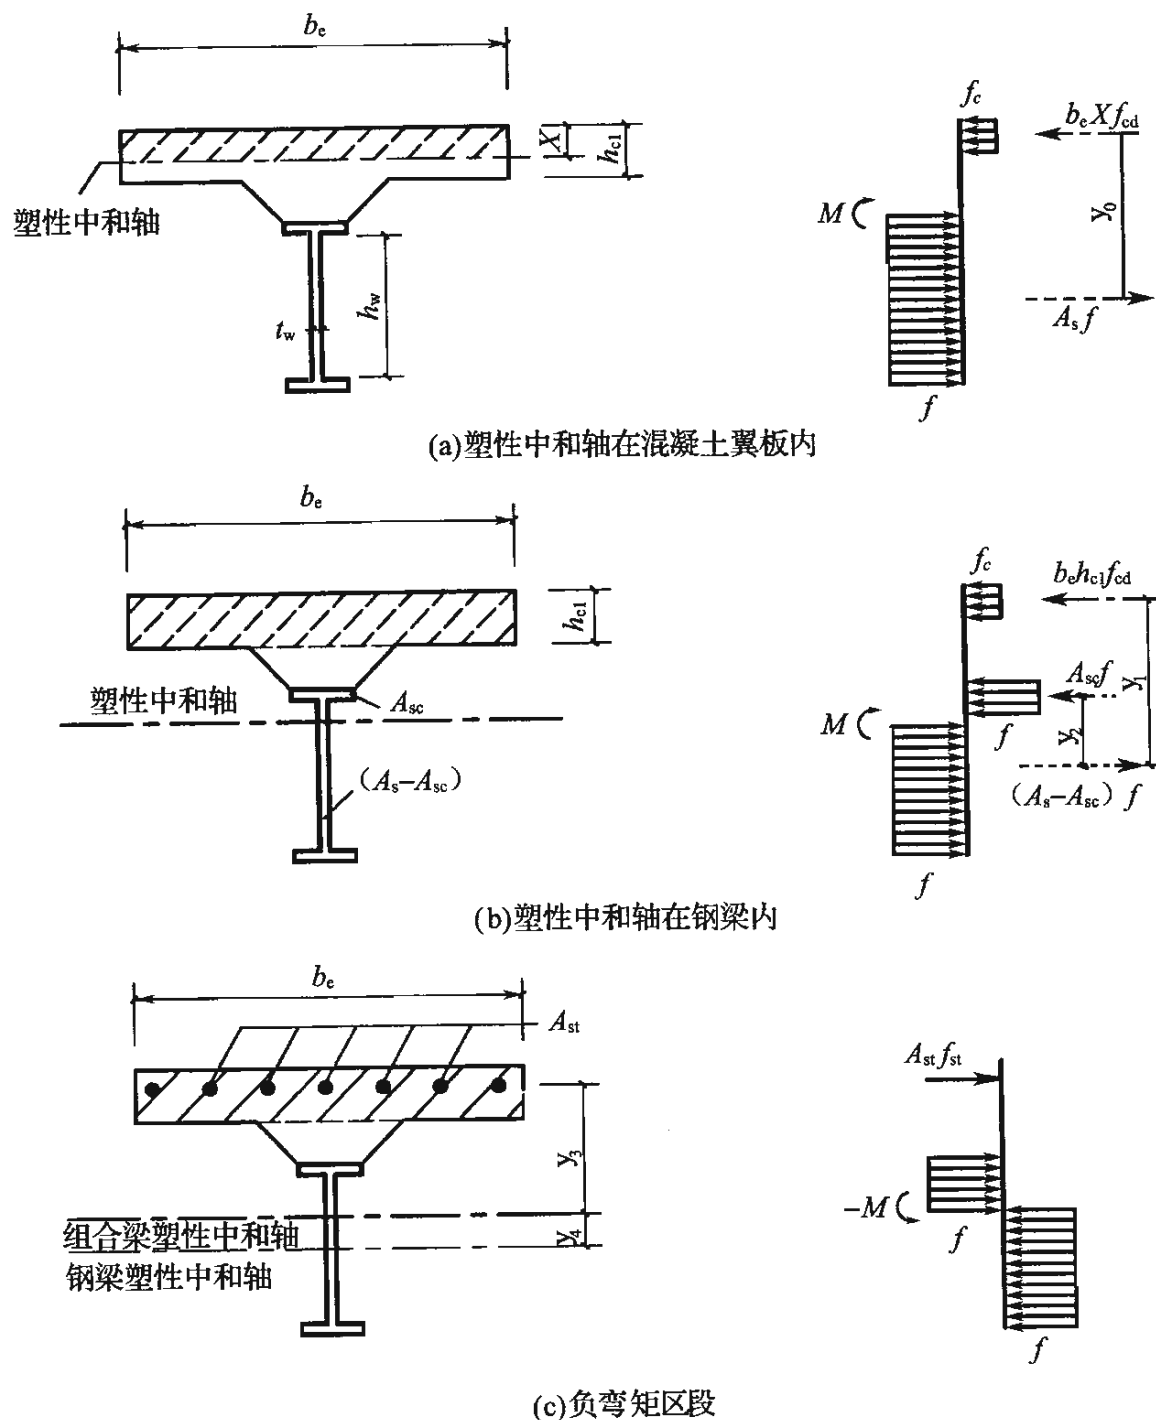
完全抗剪连接组合梁抗弯承载力计算简图
